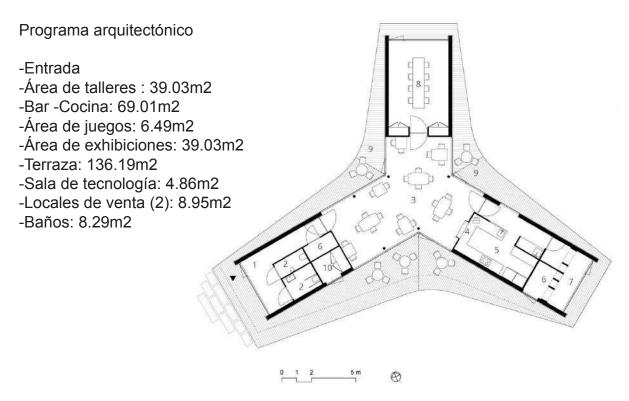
Casa de Té, Países bajos, plantageneral (recuperado en archdaily).
